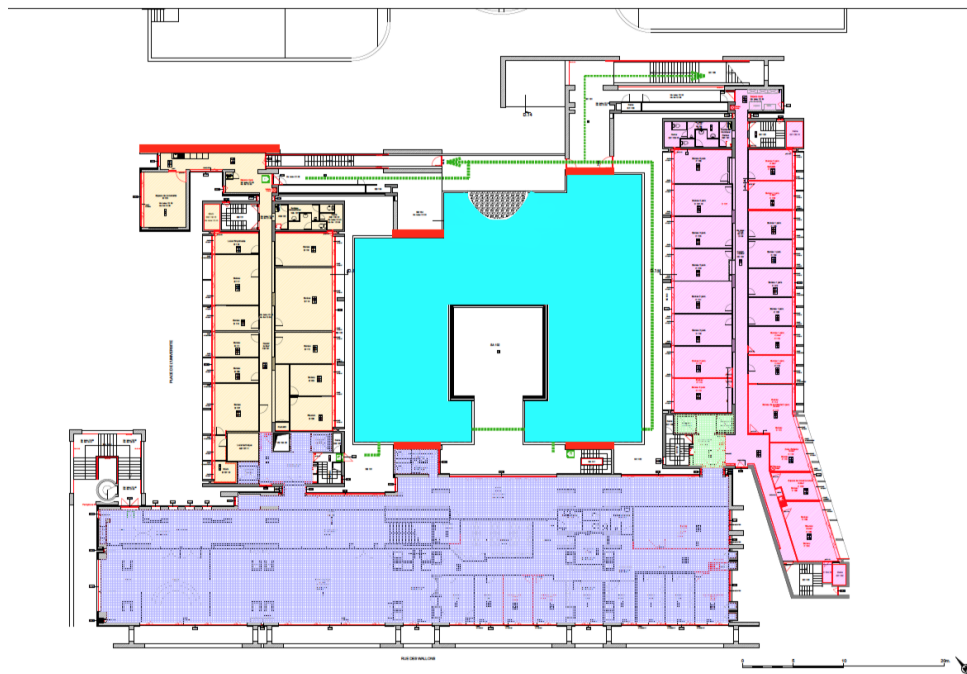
Plan du premier étage du bâtiment des Halles
